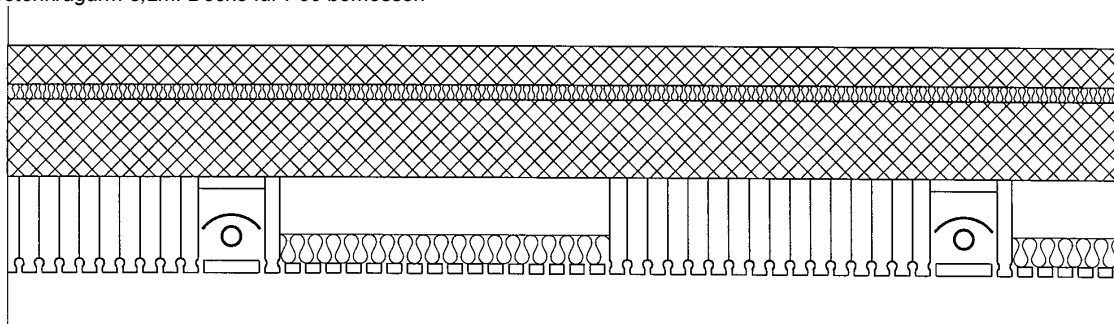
Deckenquerschnitt Kantonsschule Kreuzlingen: 200mm gedübelter Brettstapel + 140mm Überbeton.
